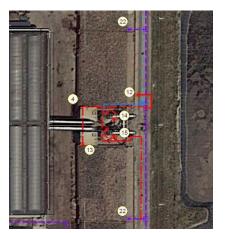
zone (2) triturazione legno e (3) upgrading – Planimetria e P&I
